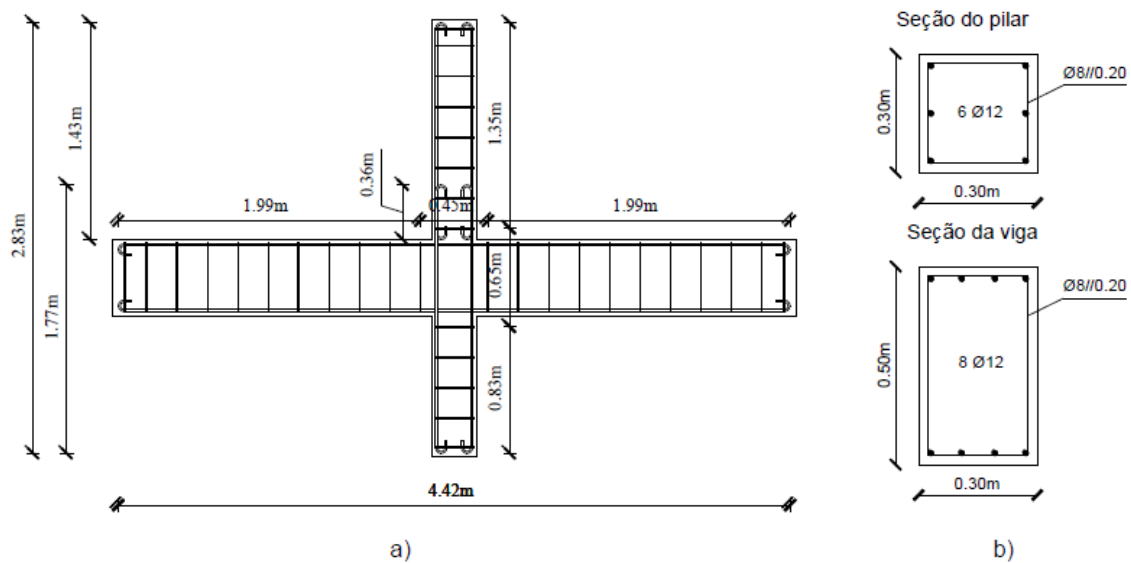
Armadura do provete IPB: a) planta; b) corte; adaptado Garcia (2011)
